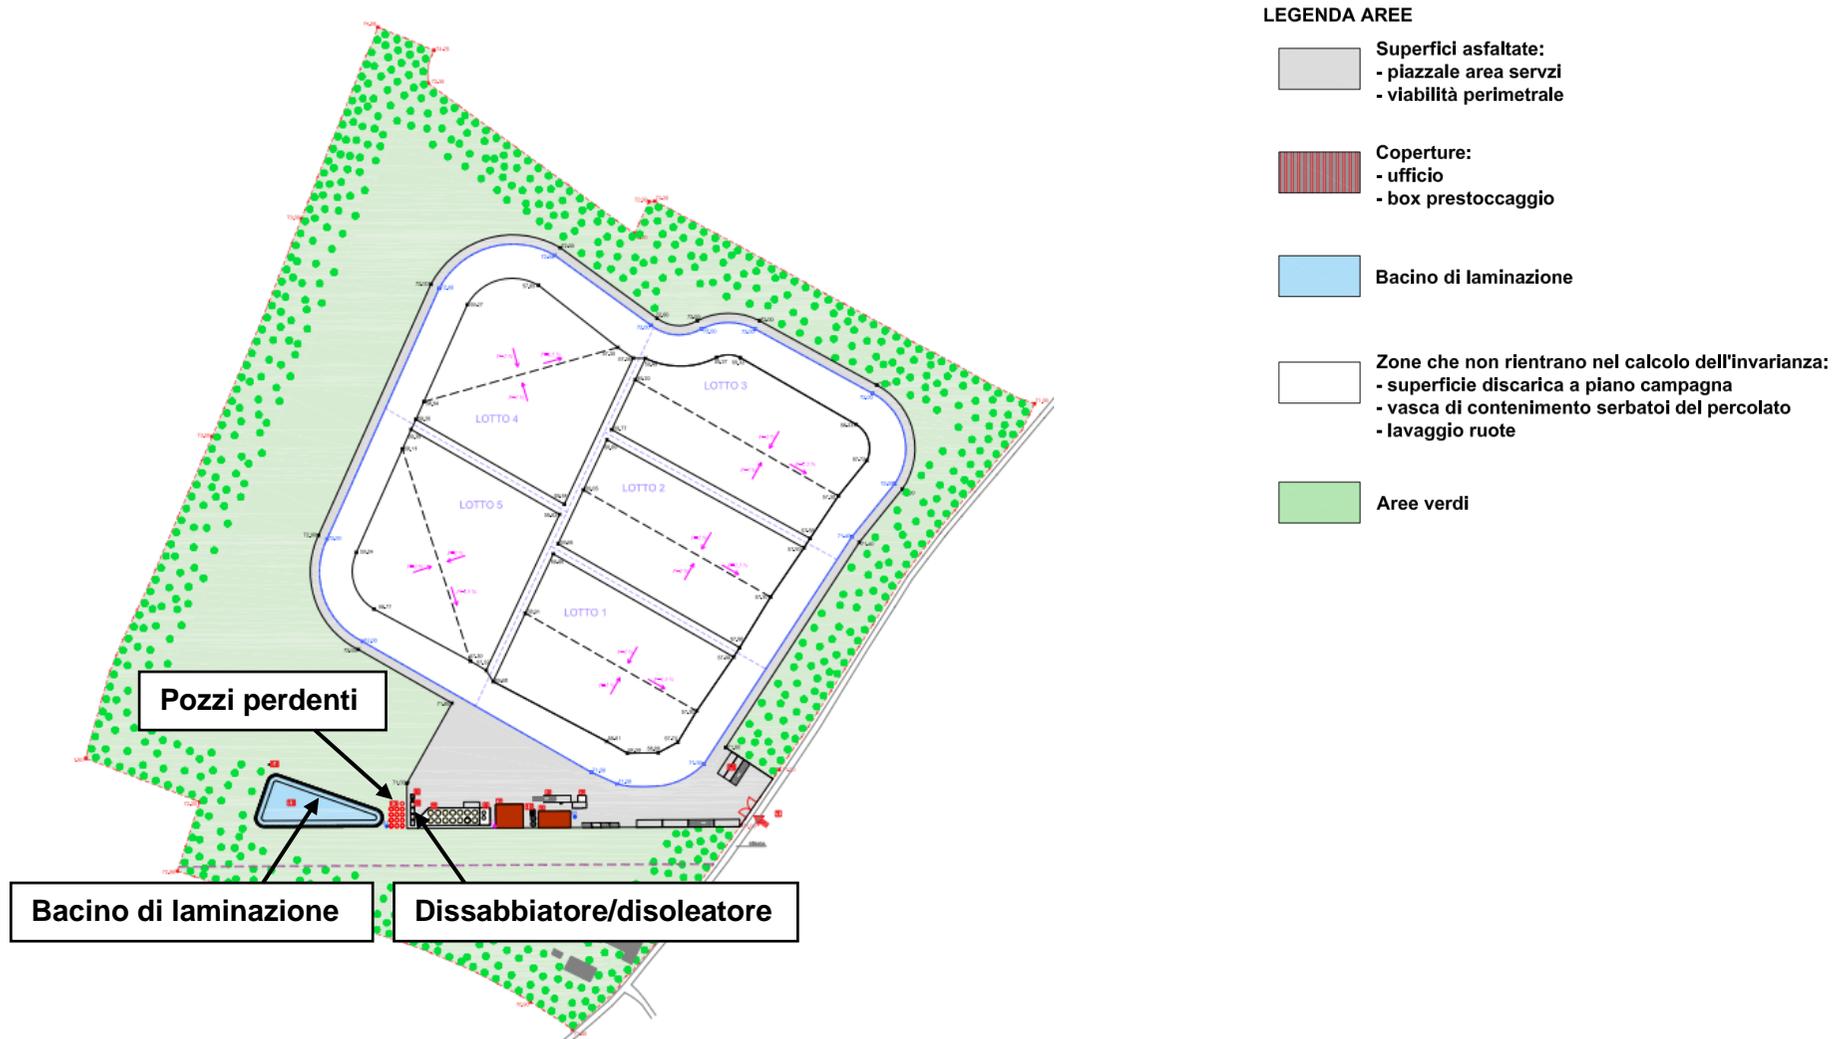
Planimetria con suddivisione delle aree di intervento in fase di gestione
